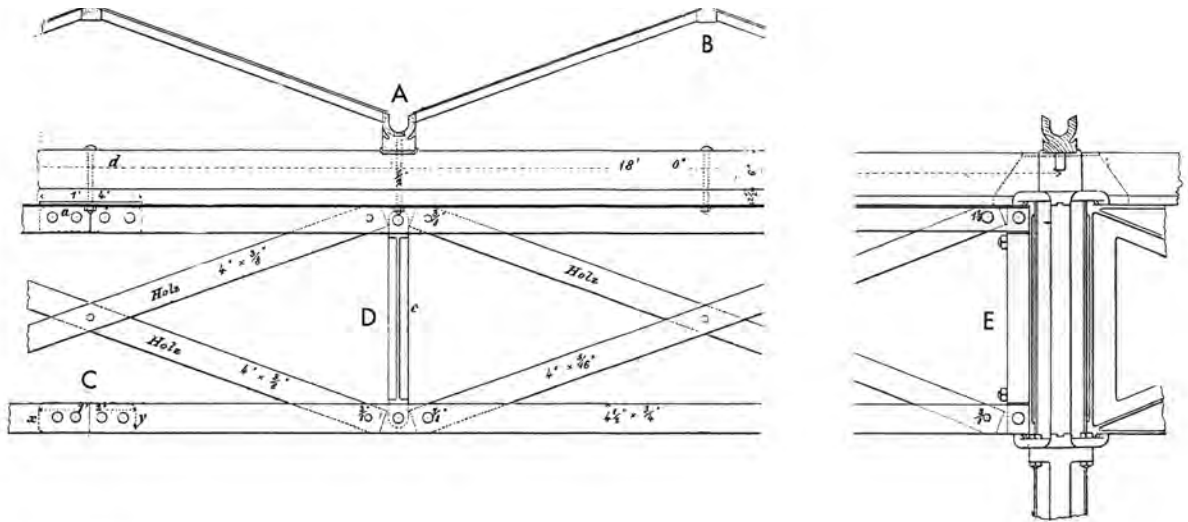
Kristallpalast als Holzkonstruktion: Binder aus Holzelementen in der Hauptträgerlage, Nebenträgerlage mit integrierter Glashalterung und Wasserableitung (Ungers 1967)
